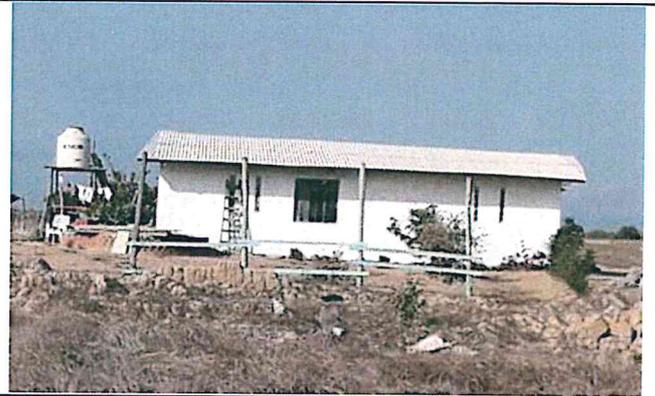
Vivienda de ladrillo, techo de calamina, buen estado de conservación.
